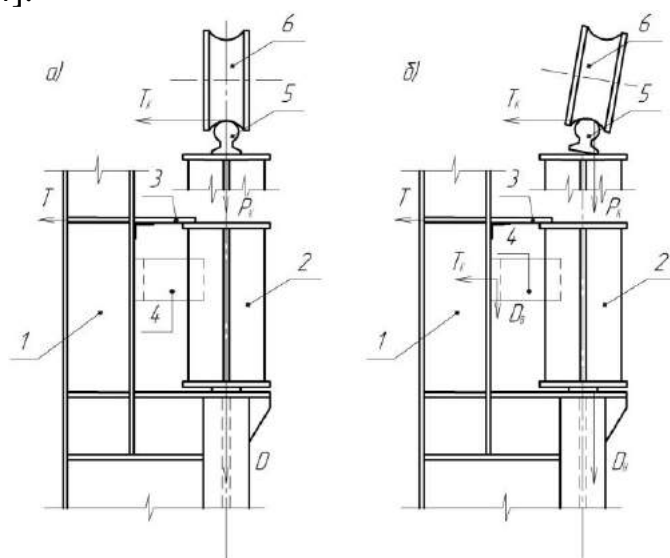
Расчетная схема подкрановых балок. Передача крановых усилий с колеса на рельс и с балки на колонну: а — принимаемая по расчету; б — действительная; 1 — колонна; 2 — подкрановая балка; 3 — соединительная планка; 4 — диафрагма; 5 — подкрановый рельс; 6 — колесо крана
